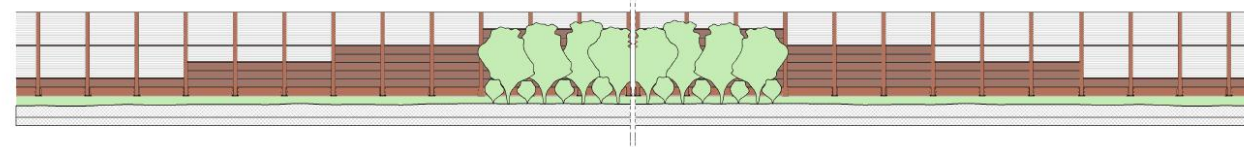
Tutela della vista del canale Bagnarolo con una barriera trasparente (fotoinserimento n° 17)
